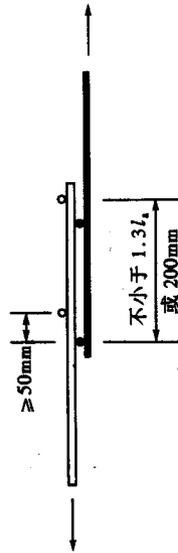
冷拔光面钢筋焊接网搭接接头
